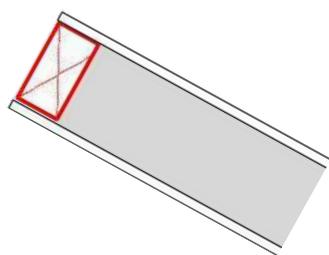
Barra interior cumbreira rebajada WT3
